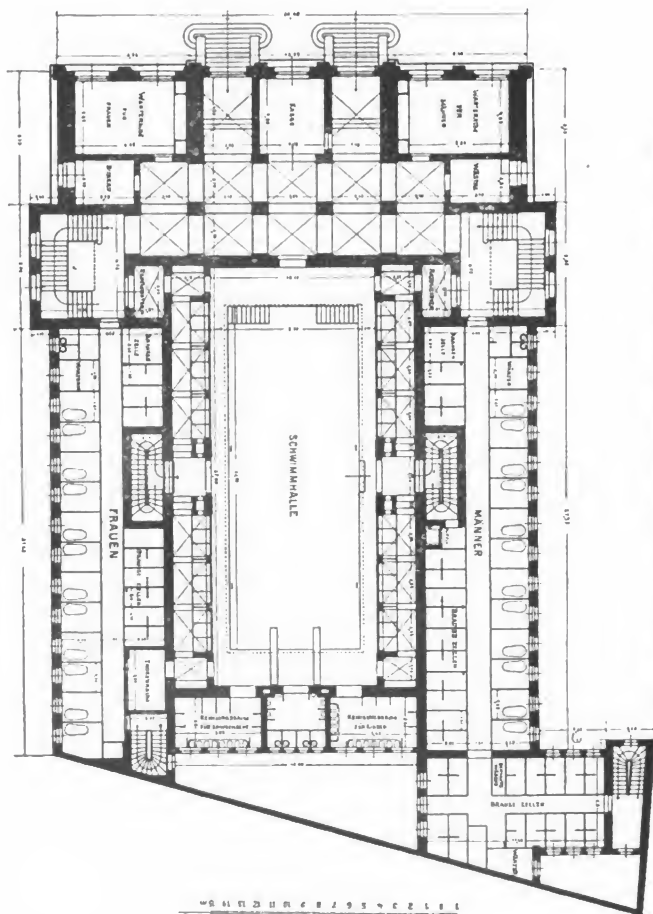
Badeanstalt in Berlin, Dennewitzstraße; Erdgeschoß.
